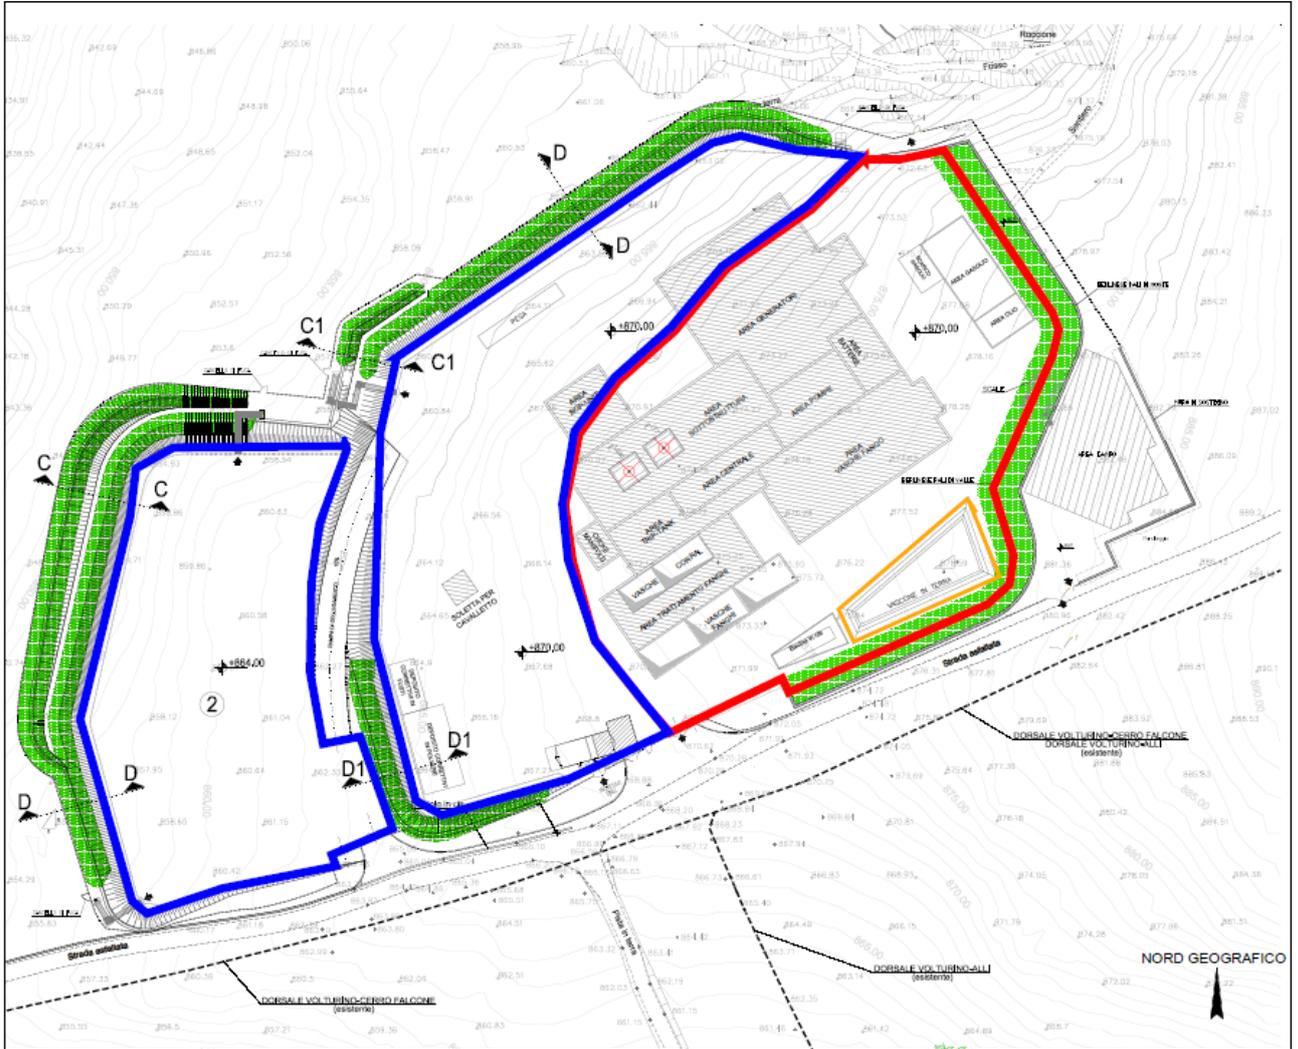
Planimetria di progetto con indicazione delle aree di scavo e di riporto
